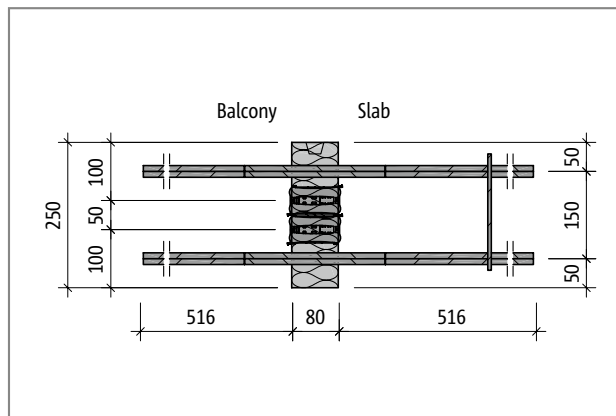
Schöck Isokorb® T type Q-E-VV5: Product layout
